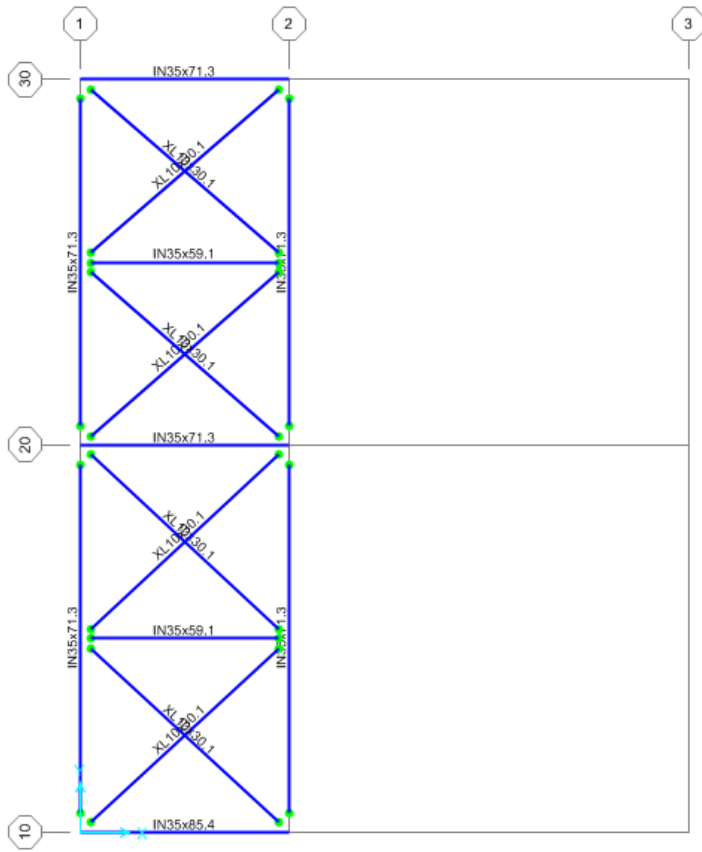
Planta Elevación 5.8 m sobre el nivel de terreno.
